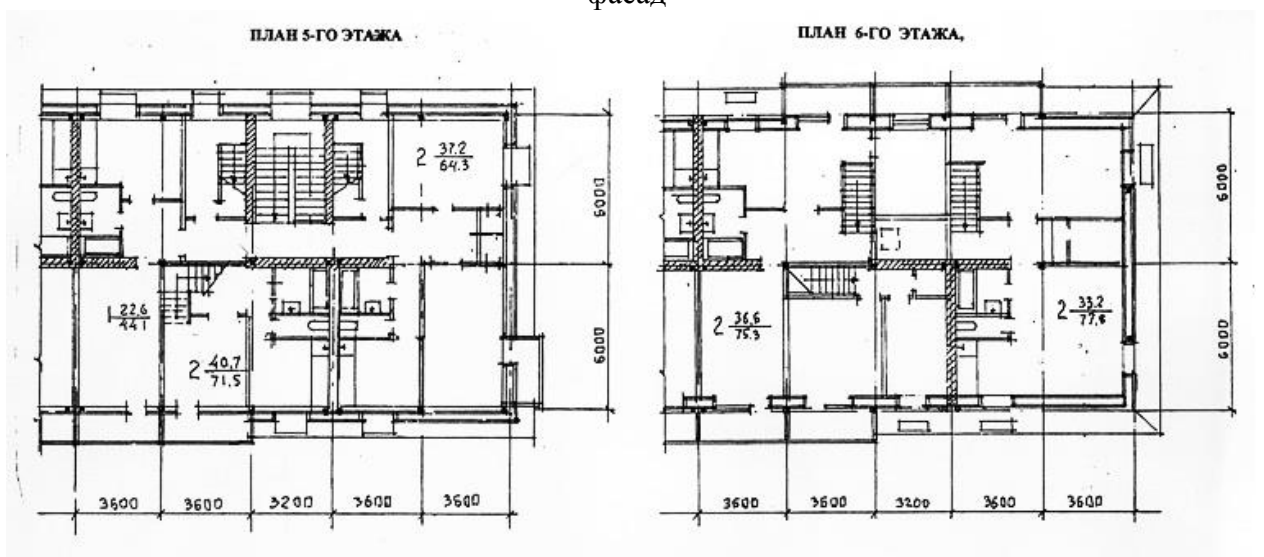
Устройство 2-уровневой мансарда с размещением 2-уровневых квартир при реконструкции 4-этажного жилого дома в г. Лыткарино. Планы секции 5-го и 6-го этажей
